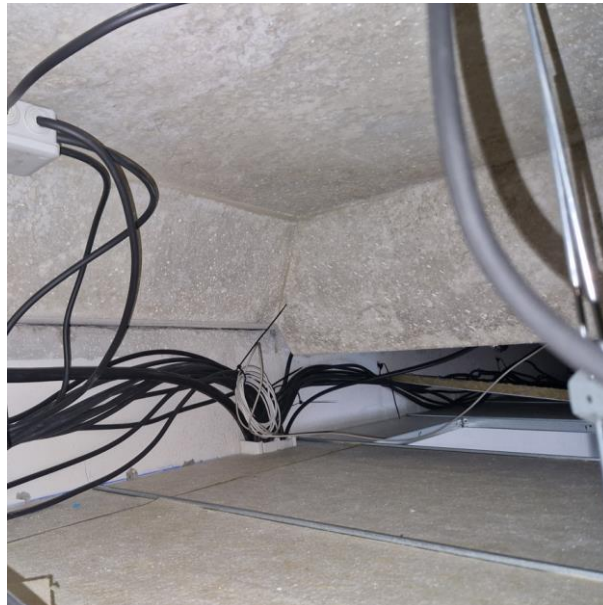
Interface entre nervure longitudinale, nervure de rive et corbeau de la poutre
